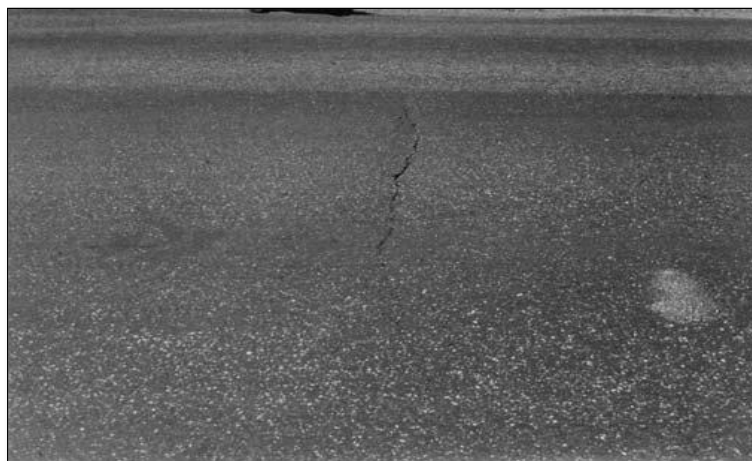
Severidad Bajo (L) Fisuras Longitudinales y Transversales
